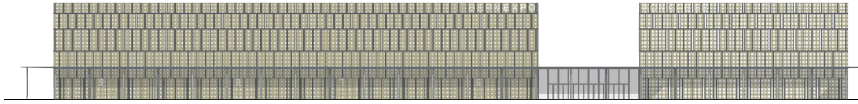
Westfassade (Quelle: Richtprojekt, 5. März 2018)
